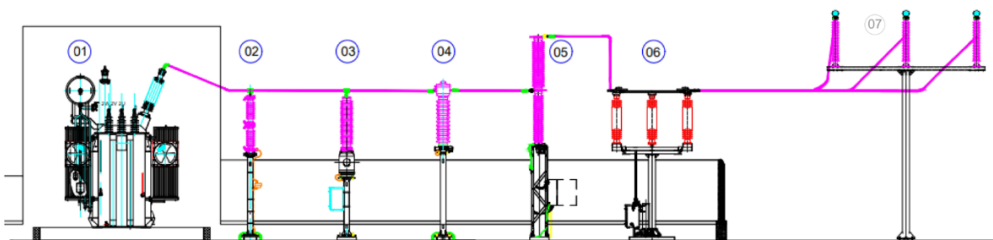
Layout della sottostazione utente e sezione tipologica della stessa
